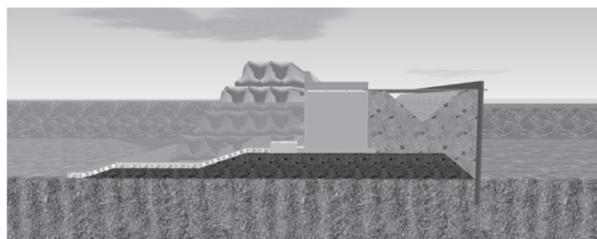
側面遮水のための鋼管矢板の打設と裏込め材の施工
